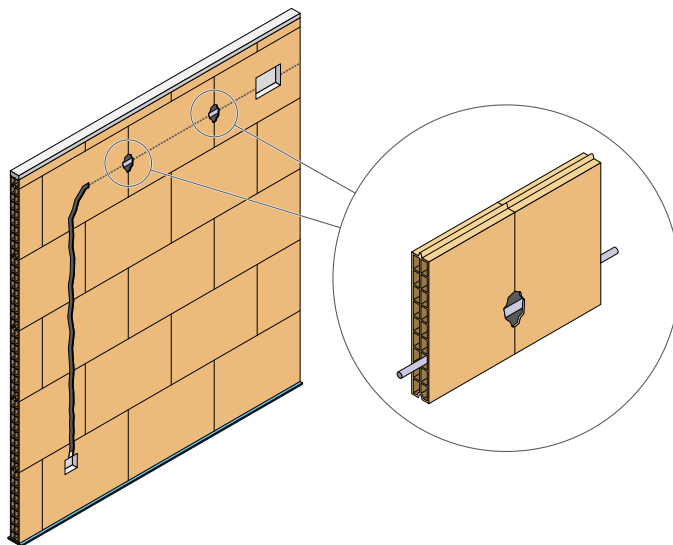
Apertura de roza horizontal rompiendo la junta vertical entre pieza y pieza.
